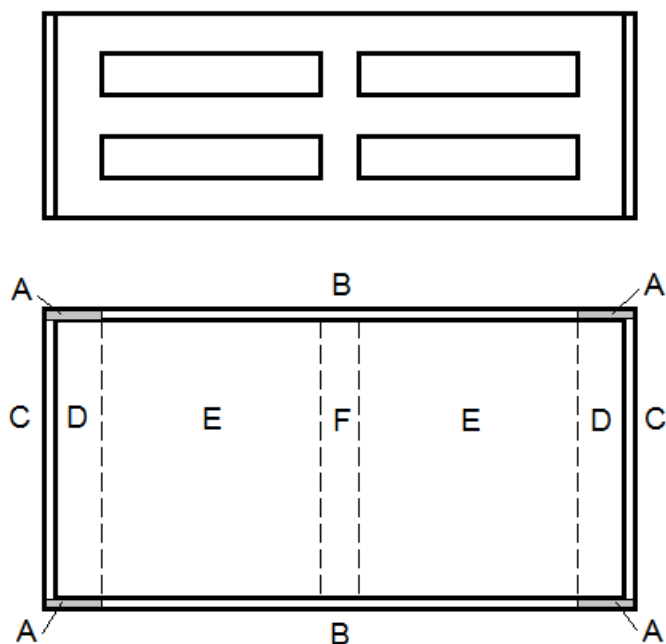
Bloco de concreto da Proposta #3 dividido em seções.
